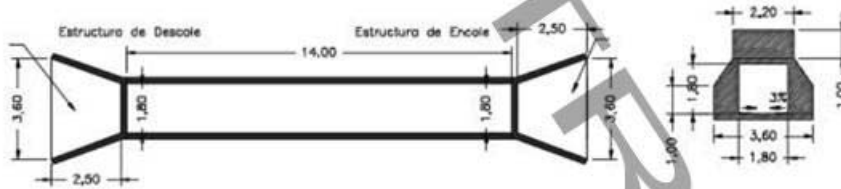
Planta del Box Culvert (Obra 3) sobre la quebrada Chuscala
